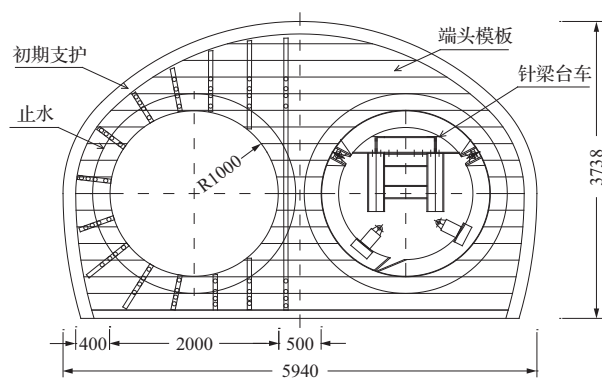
端头模板及止水布置示意图(半幅)(单位:mm)
